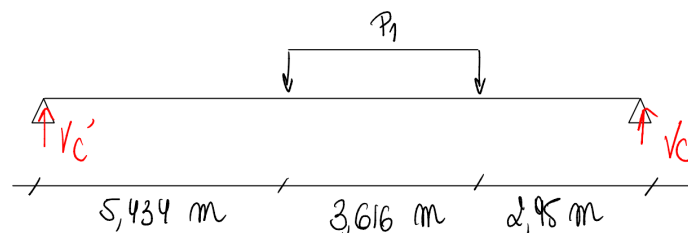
Schématisation de la poutrelle CC' comme une poutre bi-appuyée
